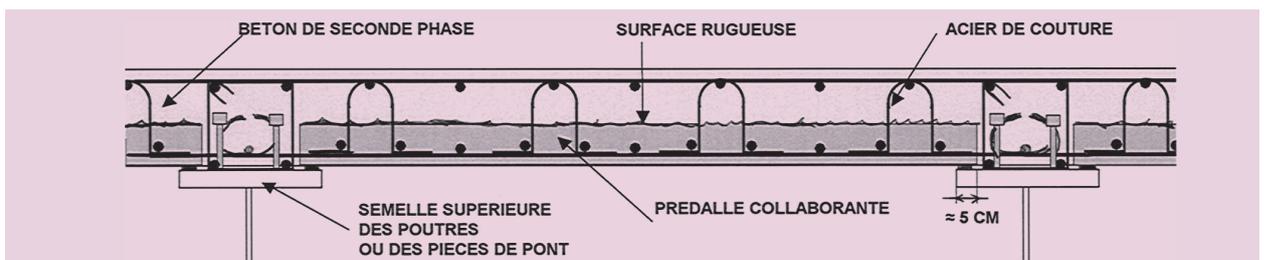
Dalle réalisée avec des prédalles collaborantes
